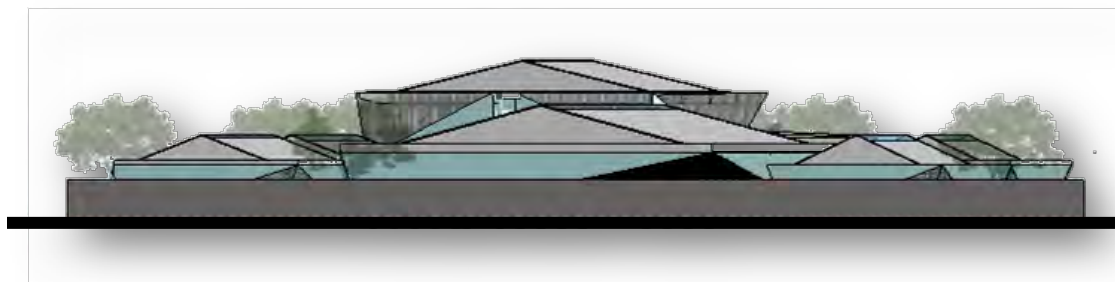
Tampak Depan Site Pabrik Tekstil
